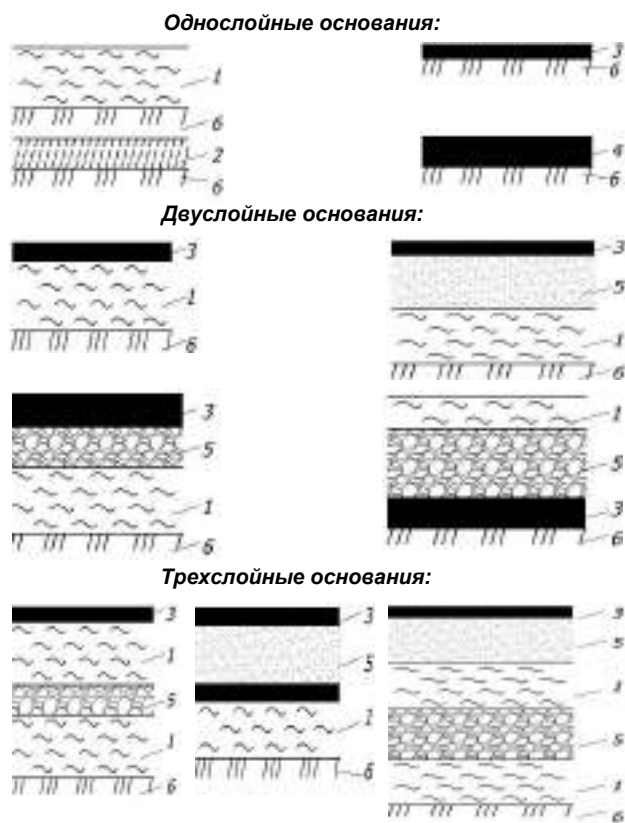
Типы оснований площадок выщелачивания: 1 – глина; 2 – бетон; 3 – геомембрана; 4 – асфальт; 5 – дренаж; 6 – грунтовое основание
